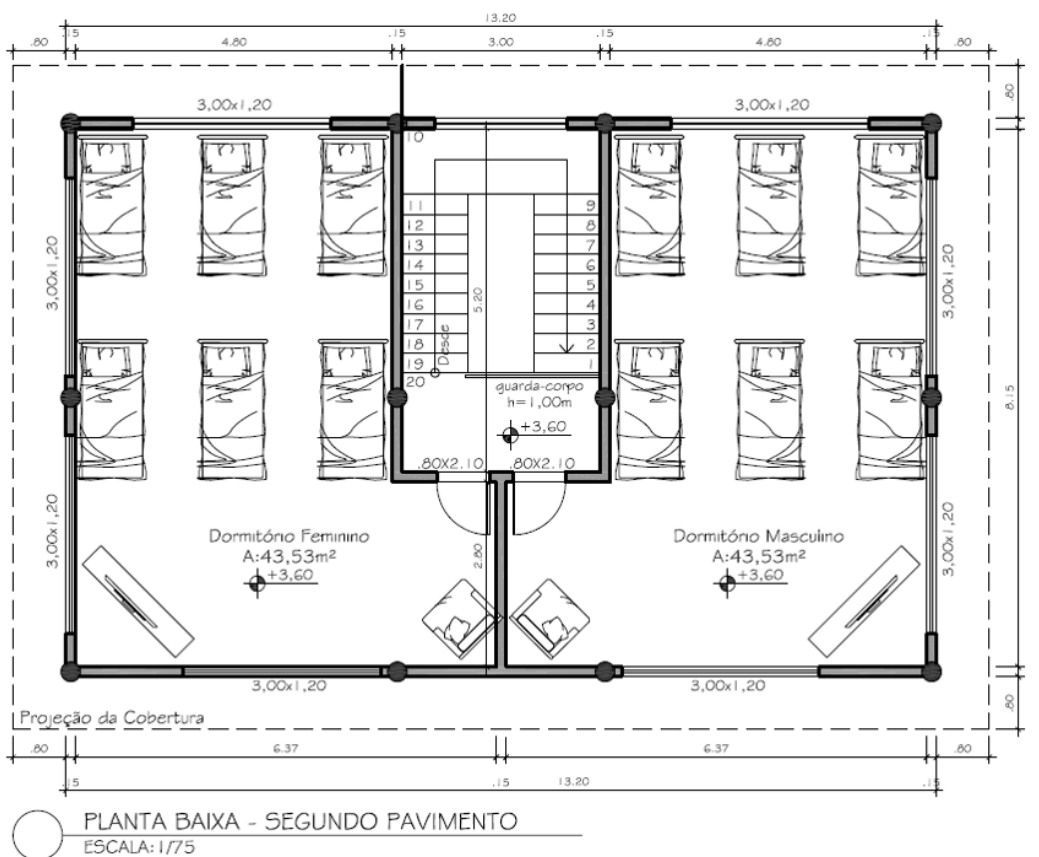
Planta arquitetônica do casarão CED, 2º andar.
